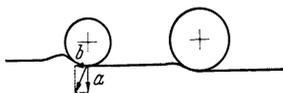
Darstellung des Kräftespieles der Walze während der Verdichtung.
